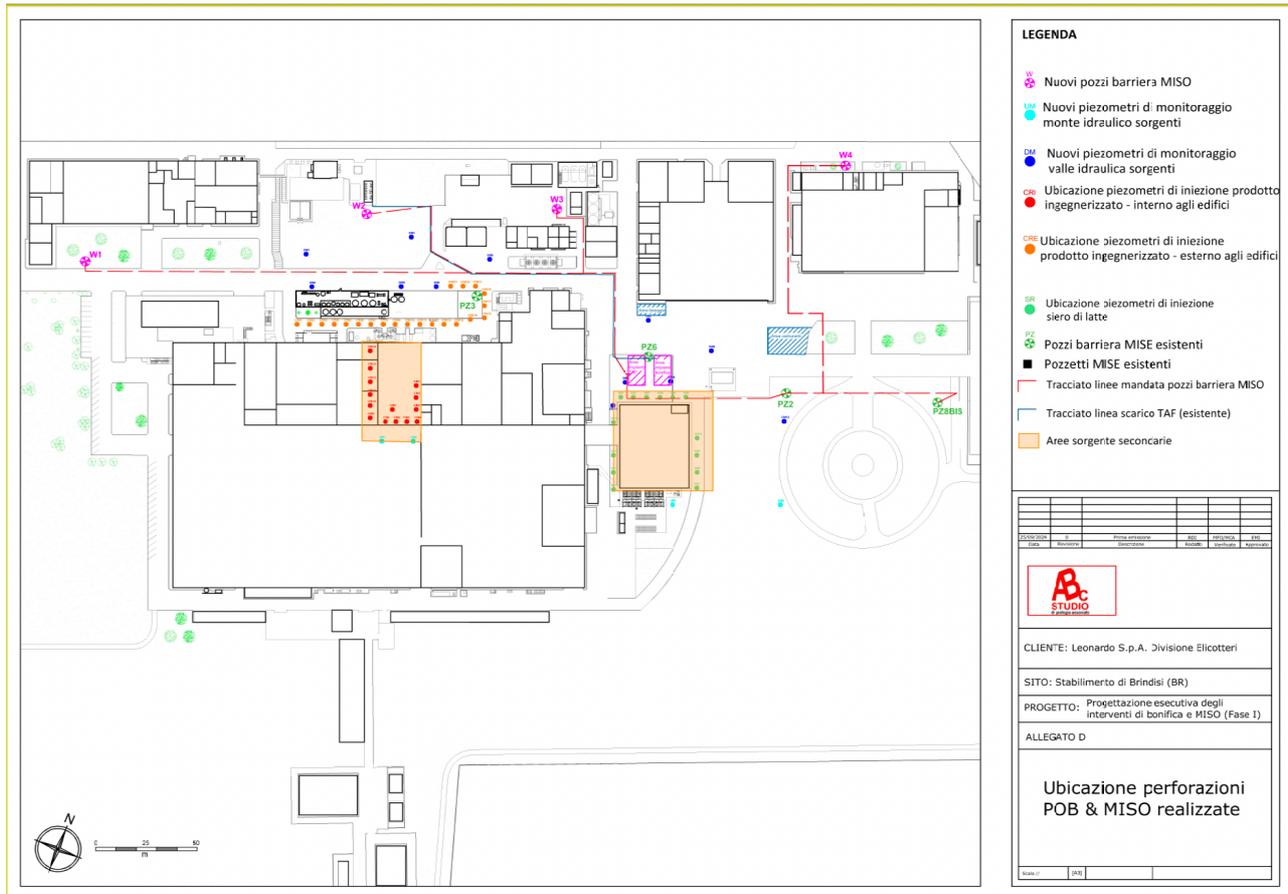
Ubicazione sistema MISO su planimetria Aree di intervento
